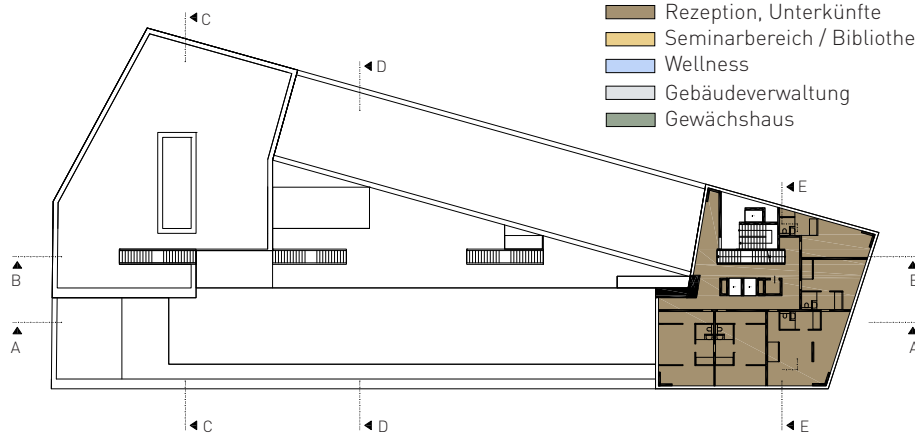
Grundriss Funktionen 4.OG +19,72m
